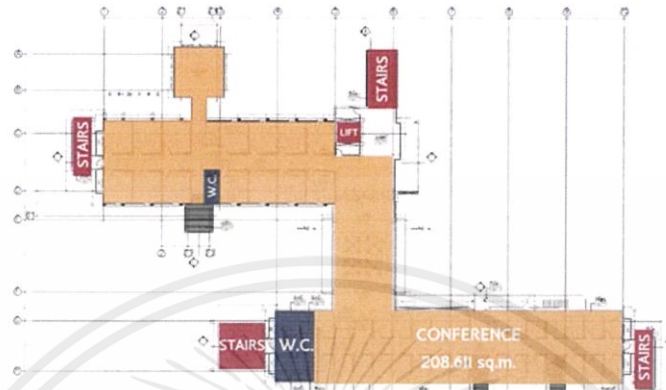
5 Zoning 1st BUILDING 2nd FLOOR
